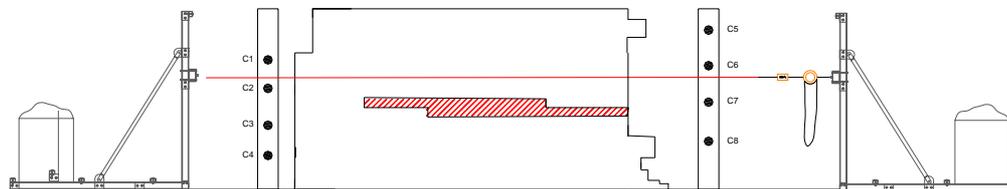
Esquema de ensaio da parede *in-situ*: pórticos de reacção, transdutores de deslocamento, dinamómetro e sistema de aplicação de forças horizontais na parede.
